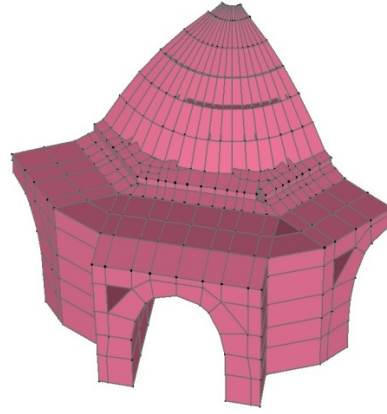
Üç boyutlu görünüm; XY planı
